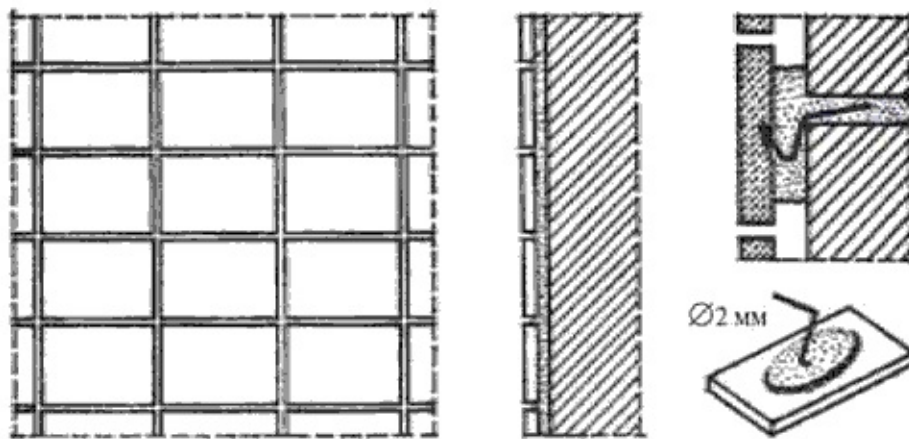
Устройство анкера при облицовке плитами из колотого сланца
